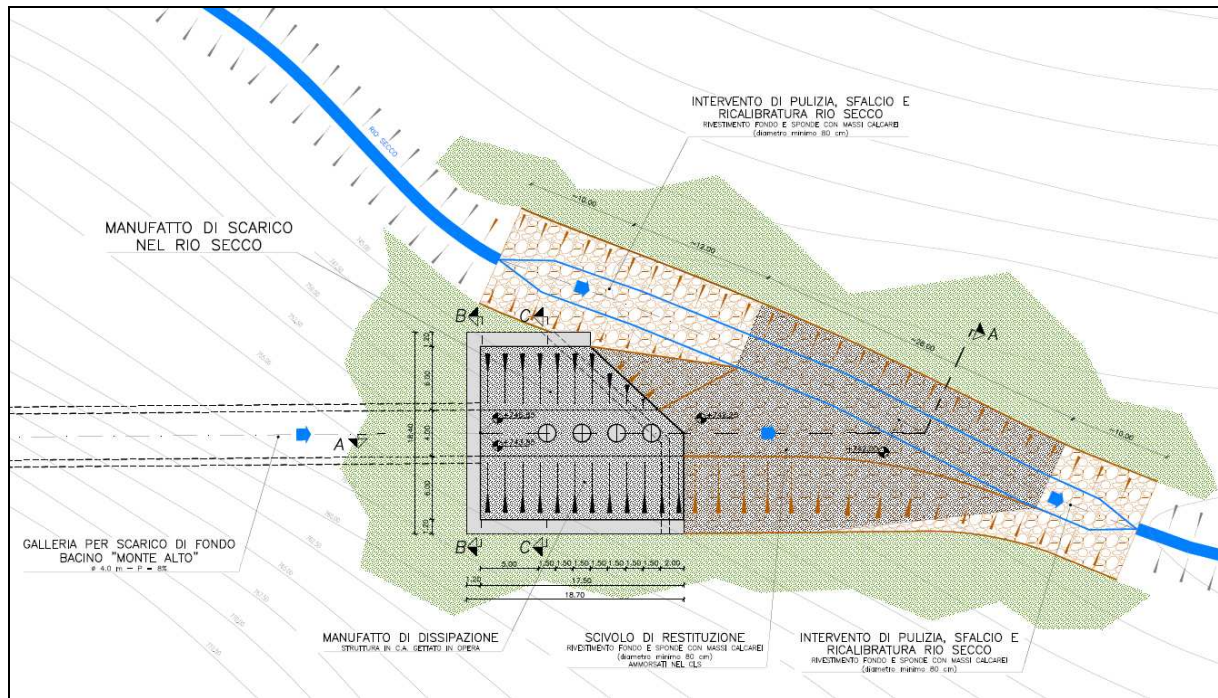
Planimetria manufatto di scarico nel Rio Secco
